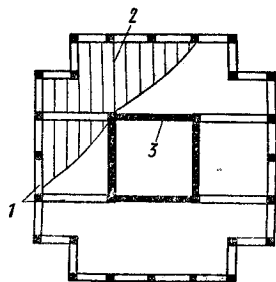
Конструктивный план многоэтажного каркасного здания с центральным ядром жесткости
